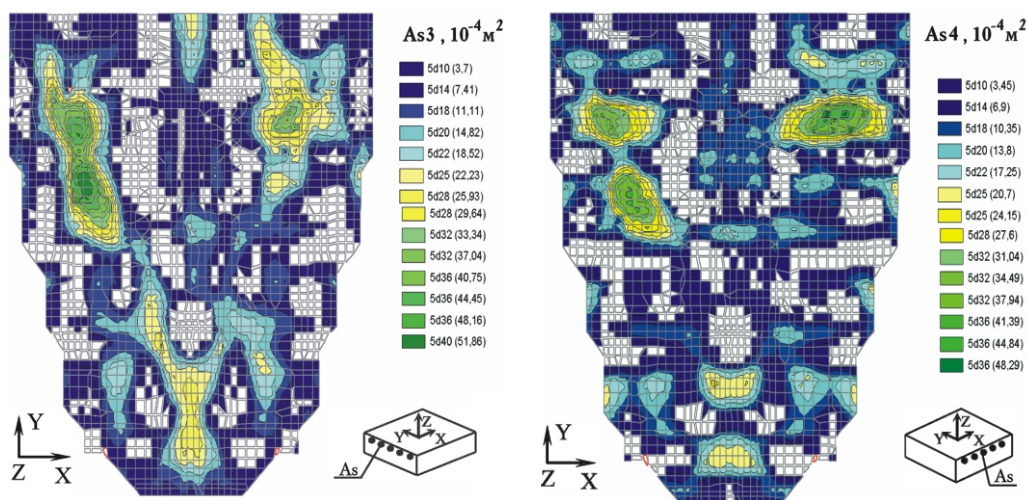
Ізополя армування верхньої зони плити фундаменту
